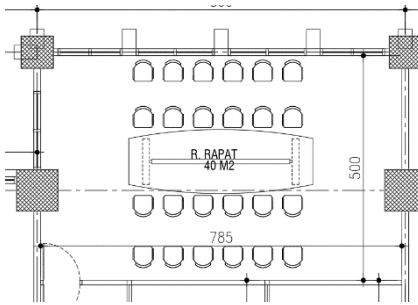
9 Denah Gedung BPKAD Pemerintah Provinsi Jawa Tengah
